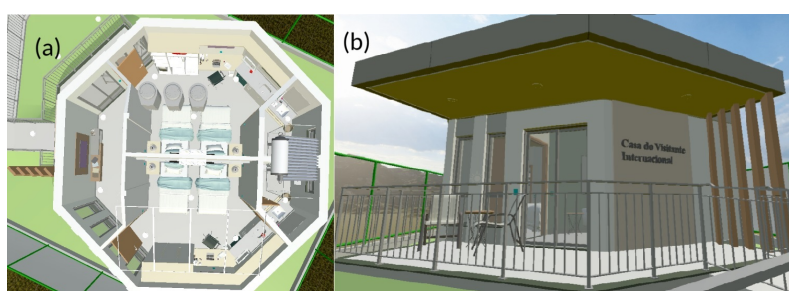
Representação da Casa do Visitante Internacional: (a) planta baixa da casa; (b) fachada da casa.
